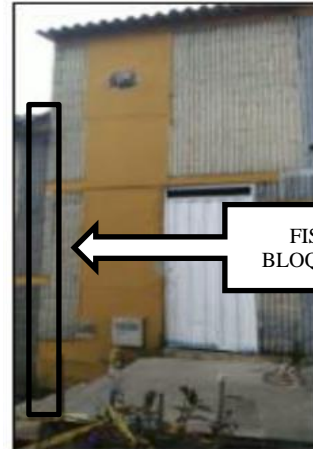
CALLE 41 A SUR No 16 A – 23 ESTE (FISURA)
